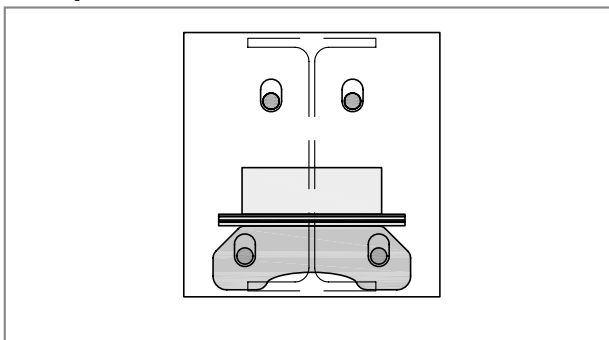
Schöck Isokorb®: raccordo acciaio – calcestruzzo armato; le piastrine distanziatrici sulla piastra a compressione innalzano le travi in acciaio di max. 20 mm
